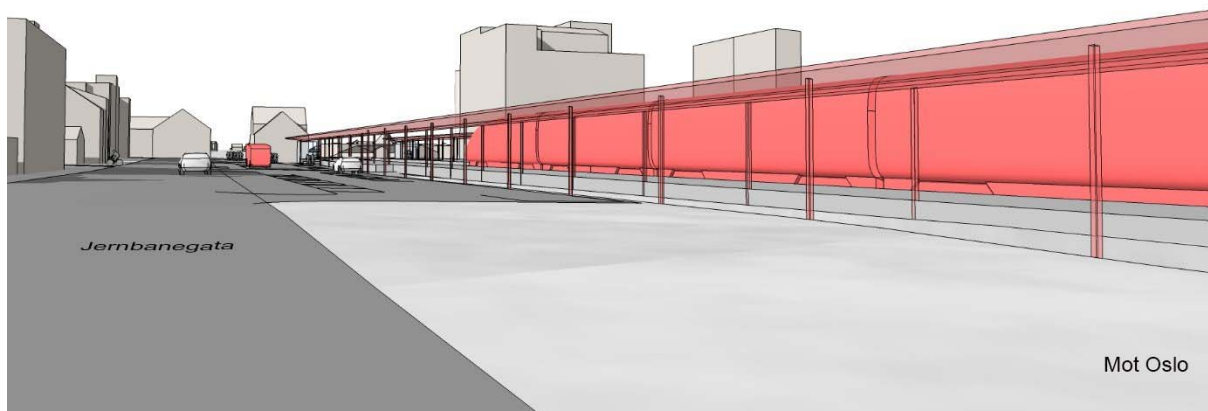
Stange stasjon. Illustrasjonsplan av mulig stasjonsutforming.
